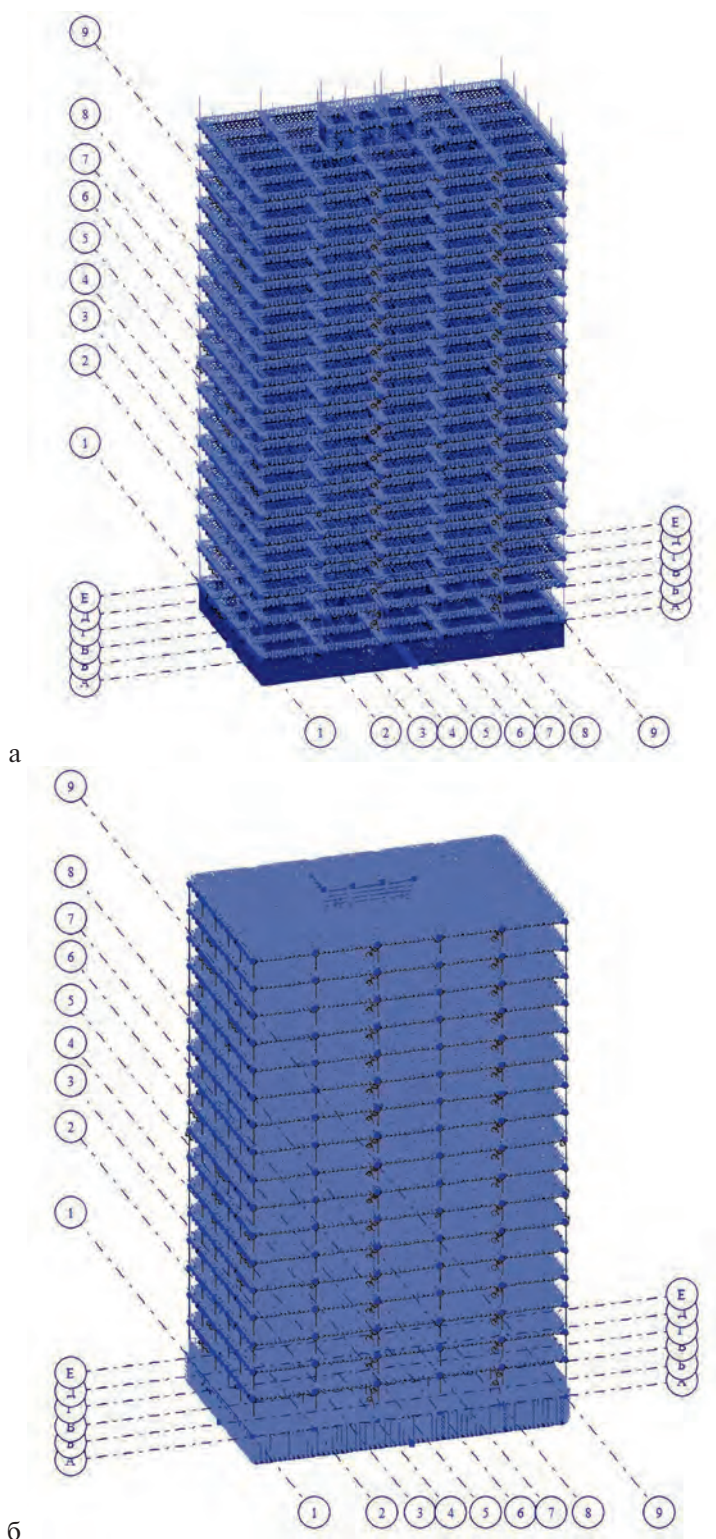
Собственный вес металлических (а) и железобетонных (б) конструкций
